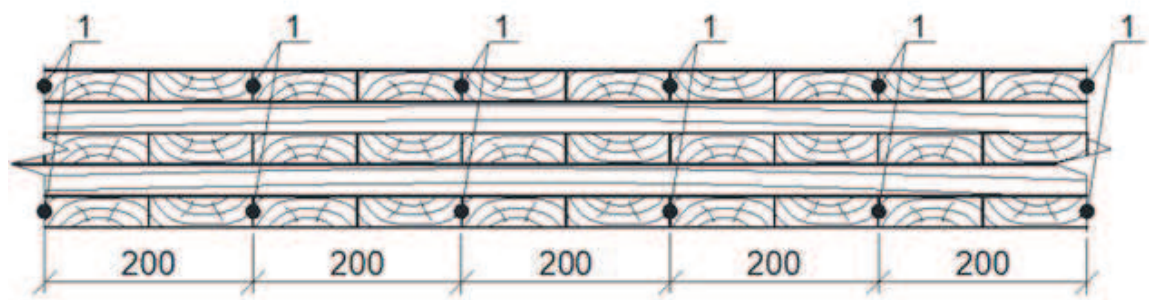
Поперечний переріз та армування CLT-панелі з кроком арматури.
